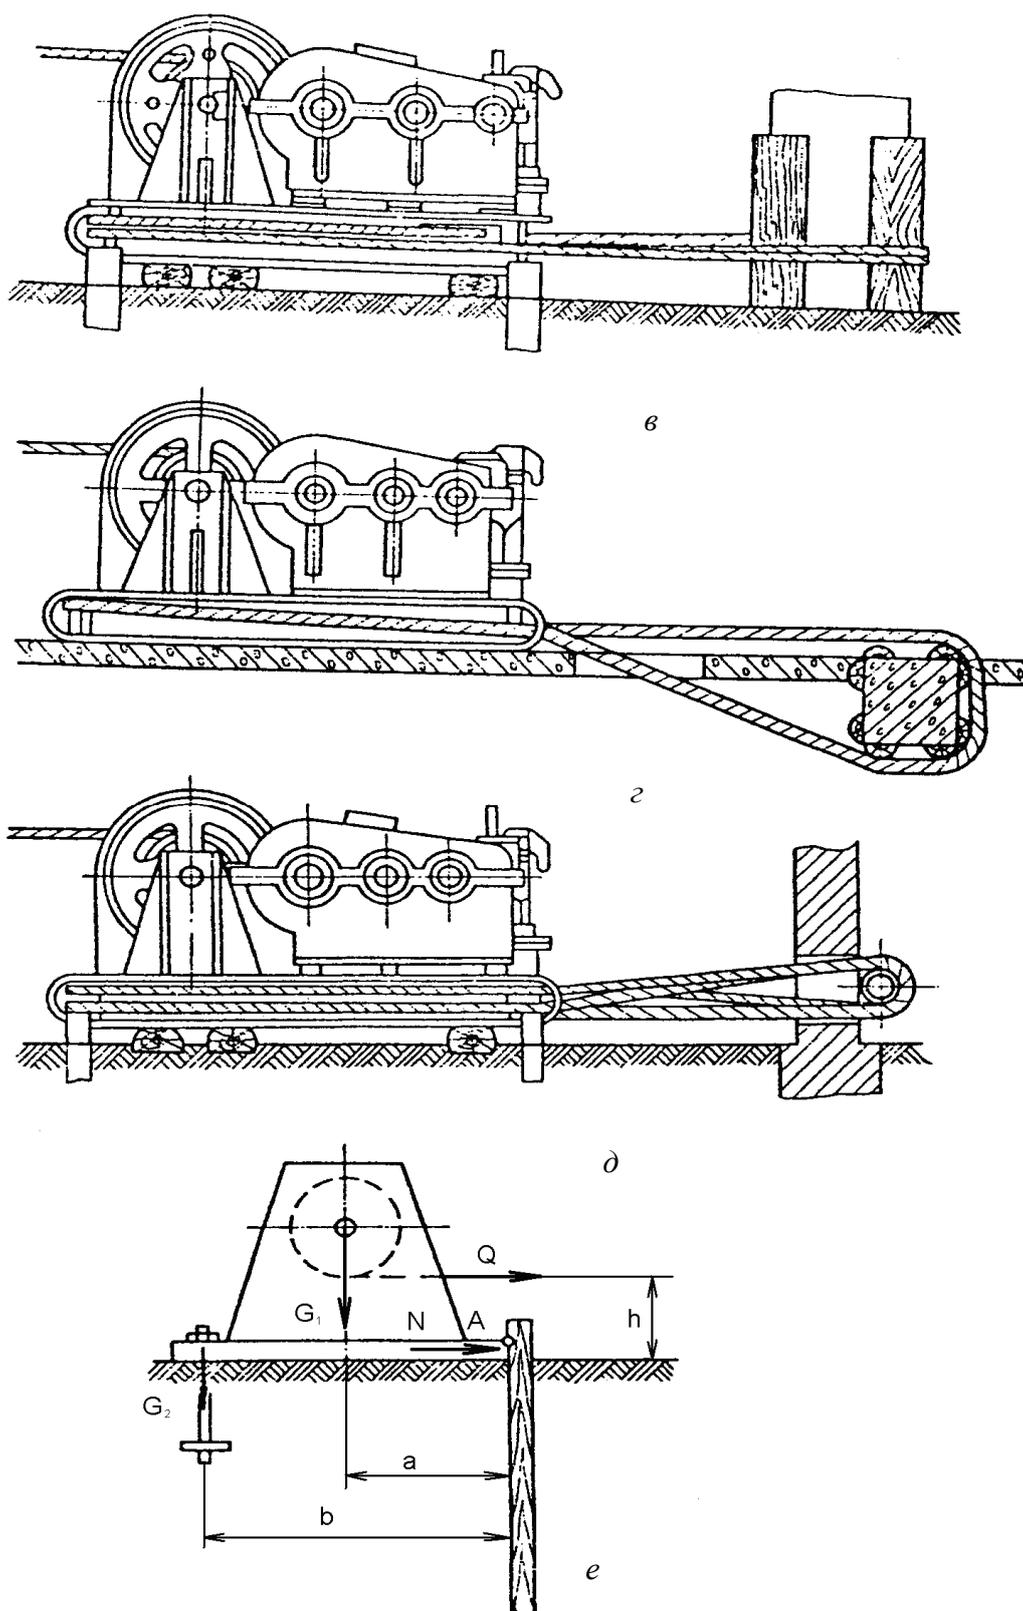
Схемы закрепления лебедок: *в* – за колонну здания; *г* – к железобетонному или металлическому ригелю перекрытия здания; *д* – к кирпичной стене; *е* – схема для расчета крепления лебедки
